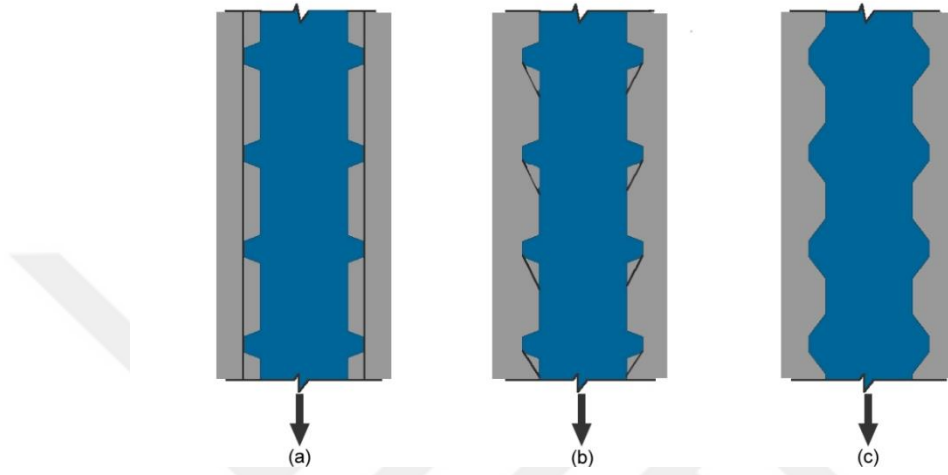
a)Donatı ile beton arasındaki mekanik kilitleme ve betonun ezilmesi
